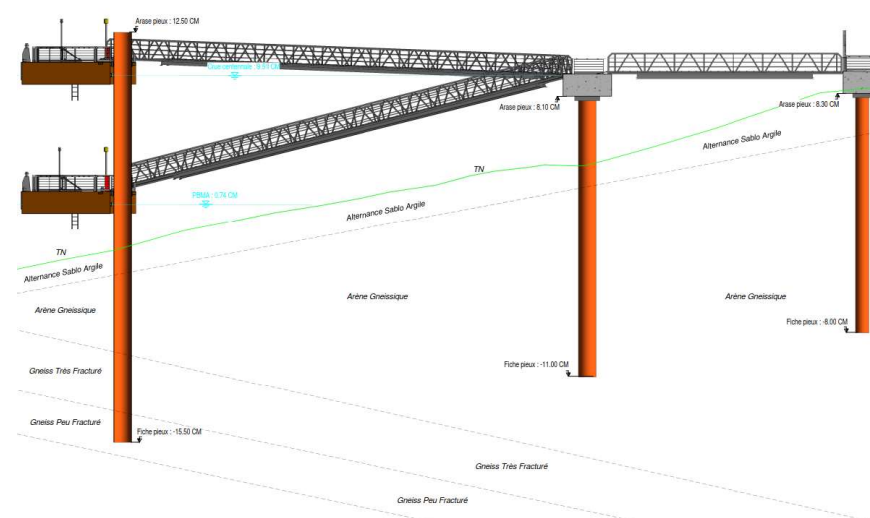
Coupe longitudinale de l'embarcadère (AVP)
